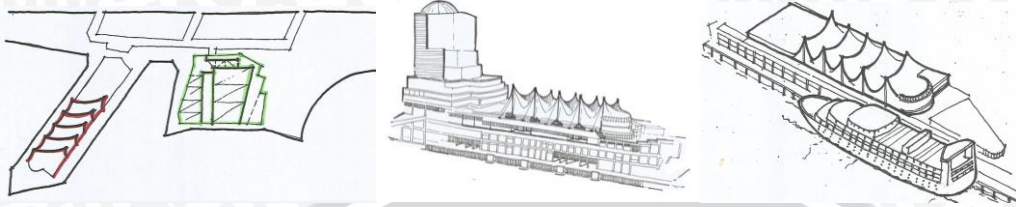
18 Penggunaan struktur pada bangunan *Convention Center
